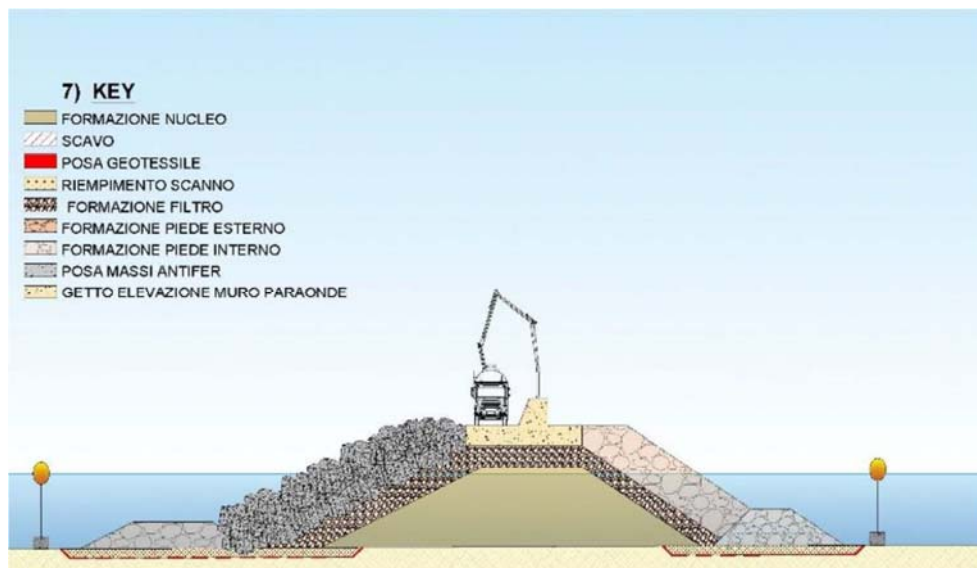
Fase 7: realizzazione elemento in elevazione del muro paraonde
